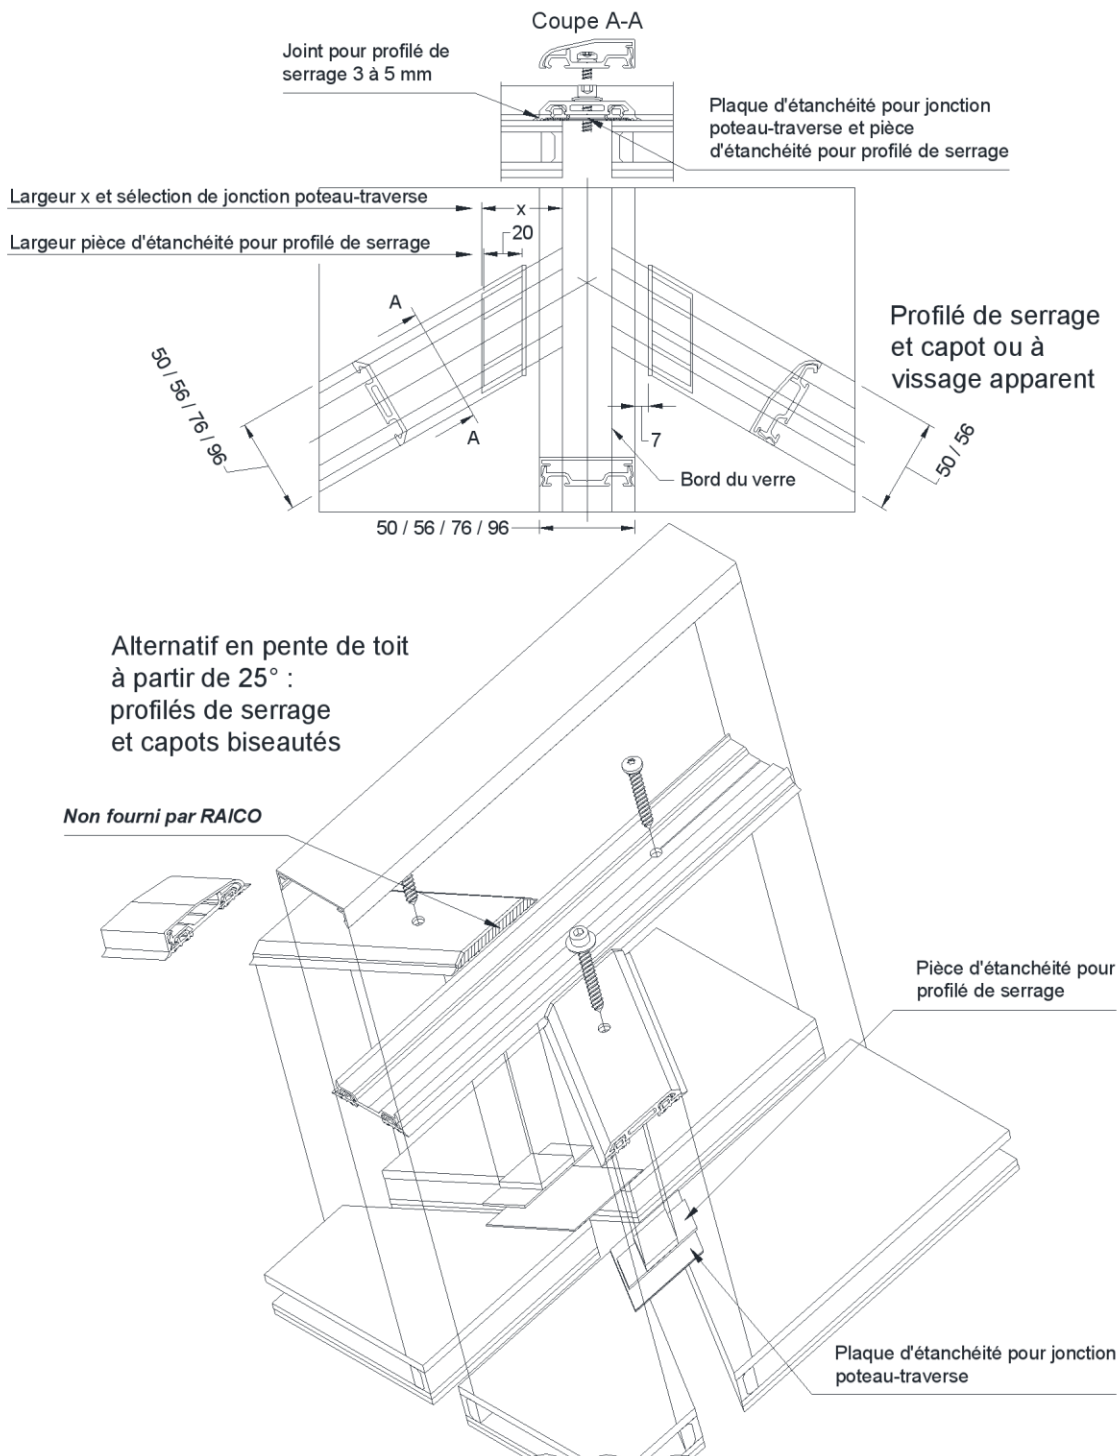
Plaques d'étanchéité et pièces d'étanchéité de profilé de serrage pour raccordement en biais
